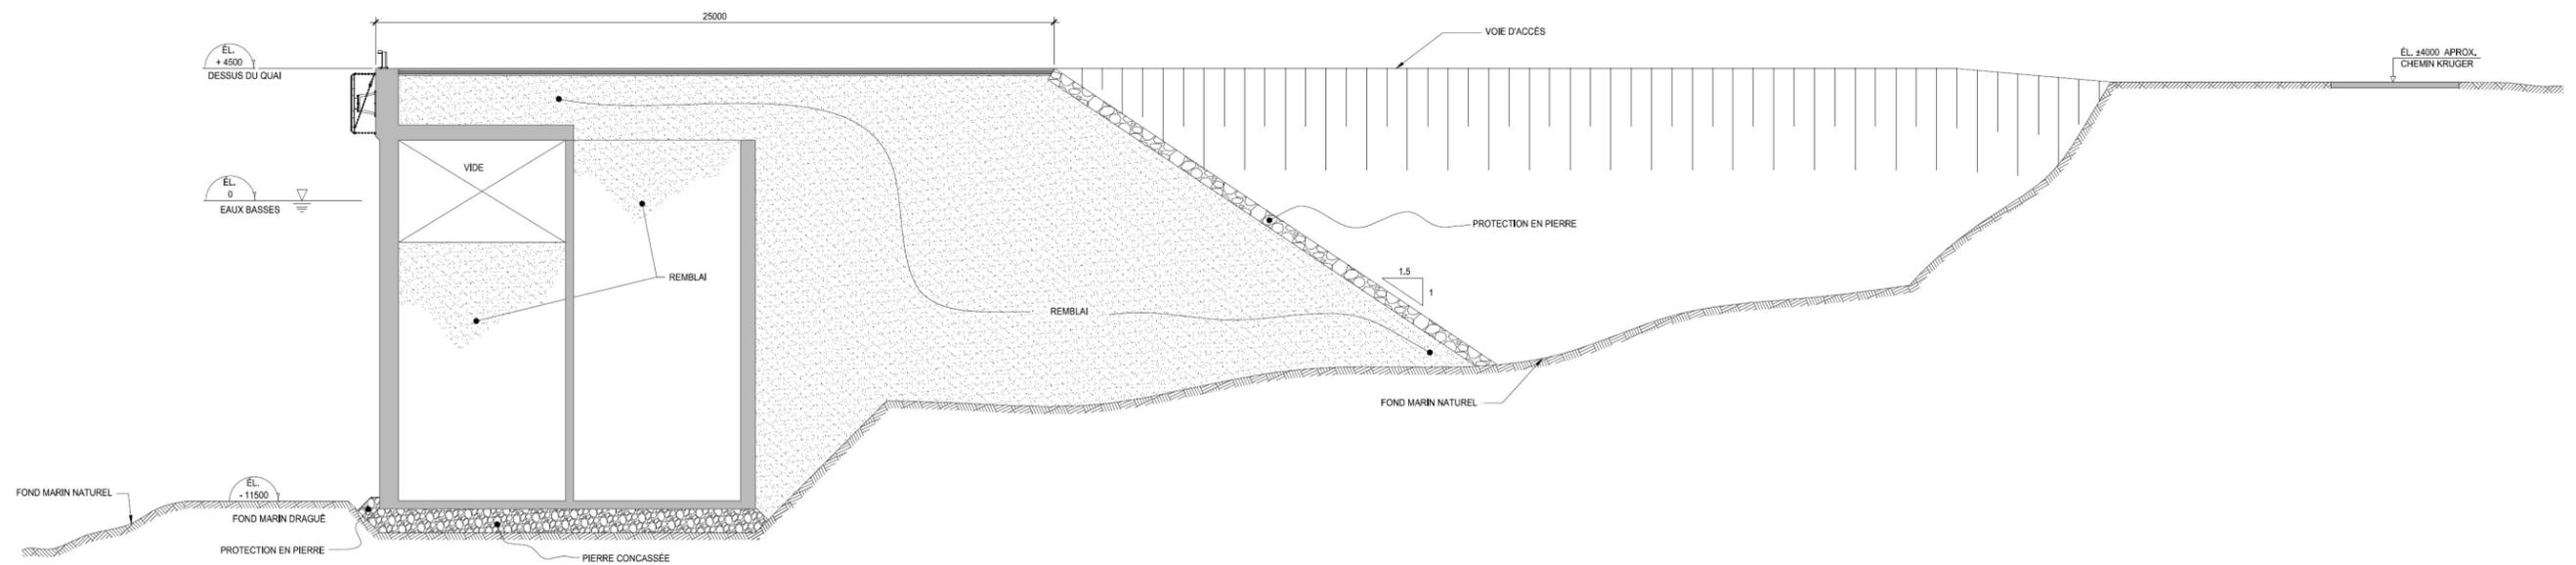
Coupe-type de la variante 2 -Caisson de béton avec aire remblayée de 25 m de large
